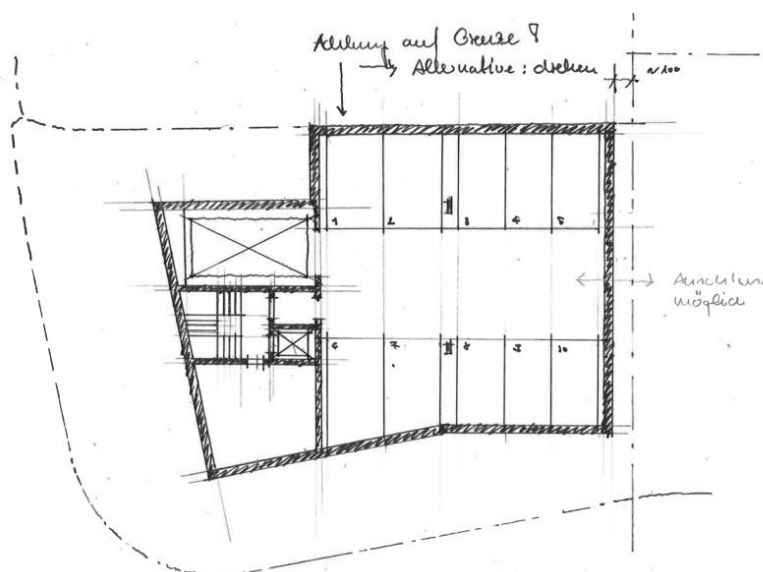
Skizze sekundäre Zufahrt mit Autolift, Untergeschoss (Stoos, 2018)
